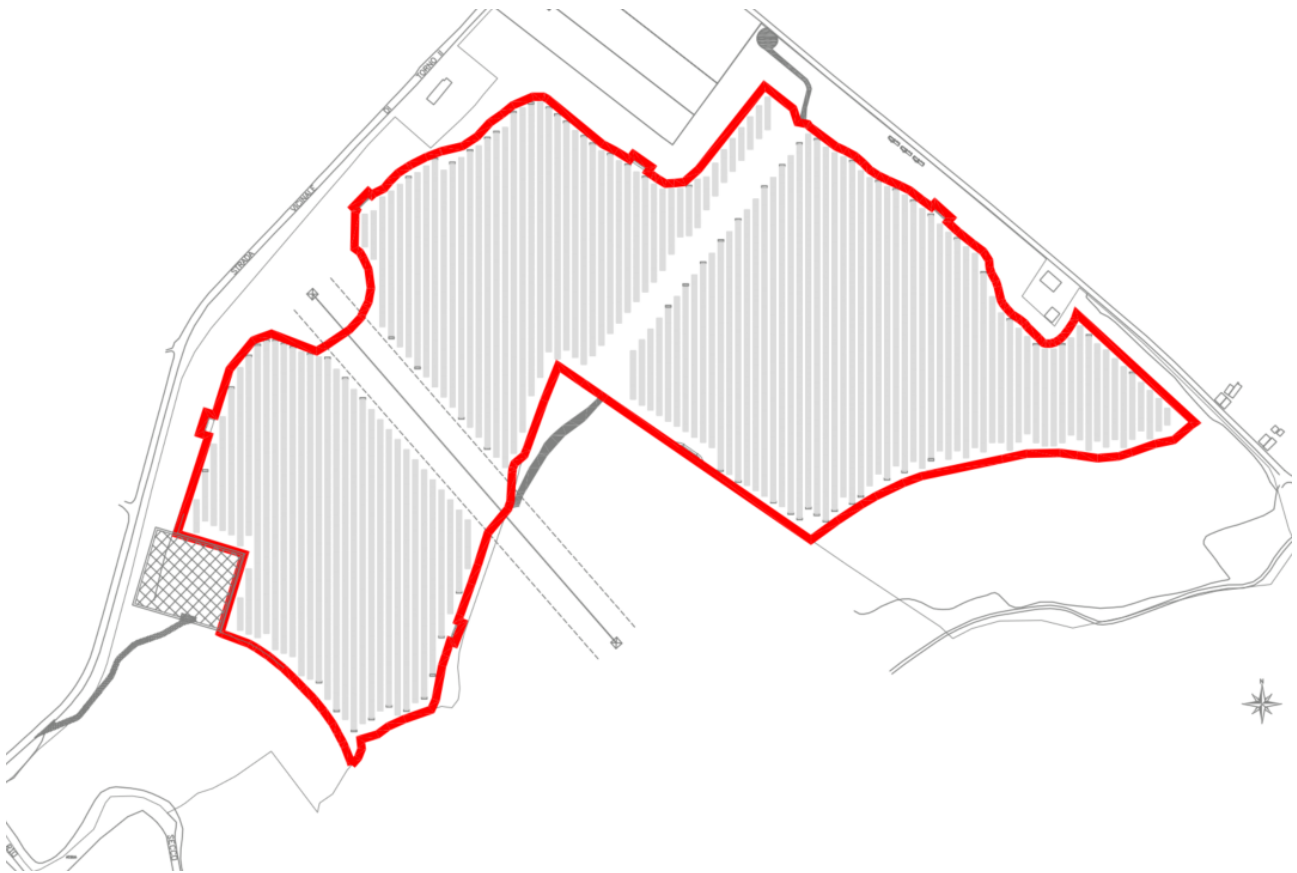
Pianta schematica della recinzione perimetrale che racchiude i tre lotti
